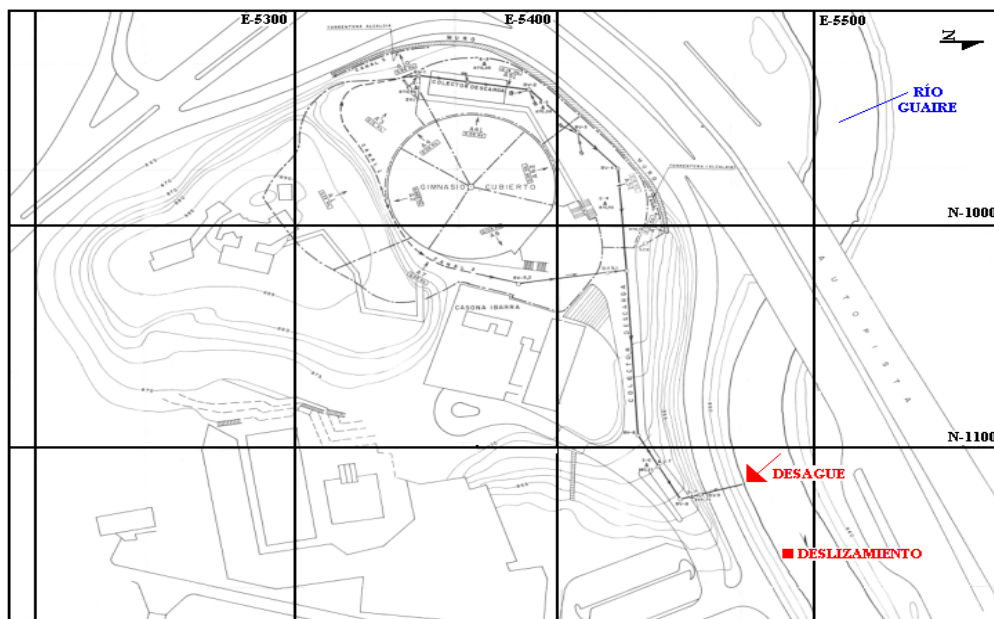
Proyecto drenaje protección del muro e instalaciones Bombero UCV, Planta General, Universidad Central de Venezuela, IMME, Facultad de Ingeniería, enero 1999, escala 1:500. Cortesía del COPRED.
